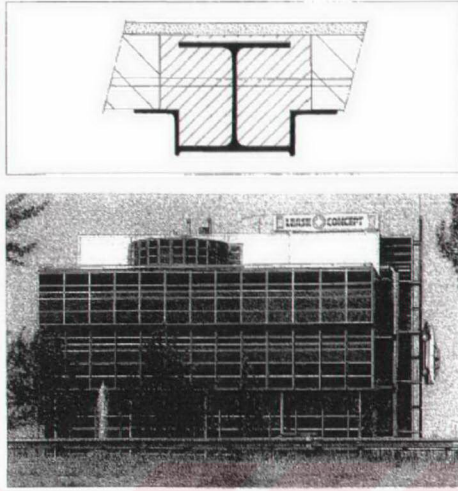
(A) Çelik kolonun içinin betonla doldurulması, (B) Çelik kolonun dış yüzeyinin betonla kaplanması (Eurofer, 1990) [5].
